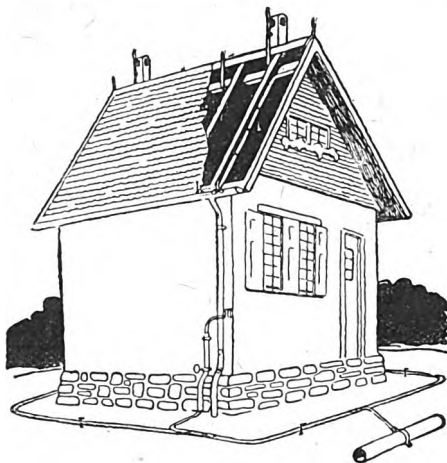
Blitzschutzanlage mit unter der Dachhaut verlegten Leitungen.
